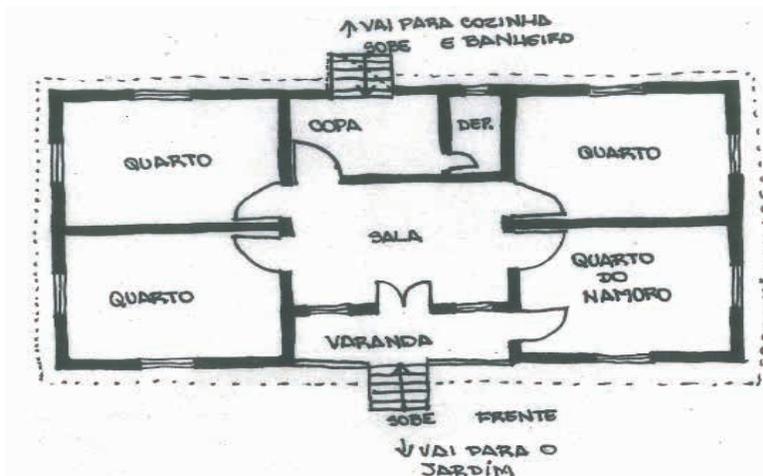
Croqui de uma planta baixa típica casa pomerana.
